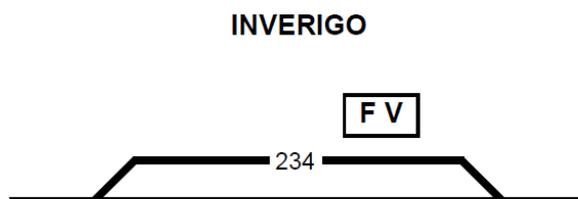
Schema planimetro della Stazione di Inverigo (fonte: Prefazione all’Orario di Servizio FerrovieNord S.p.A.)
